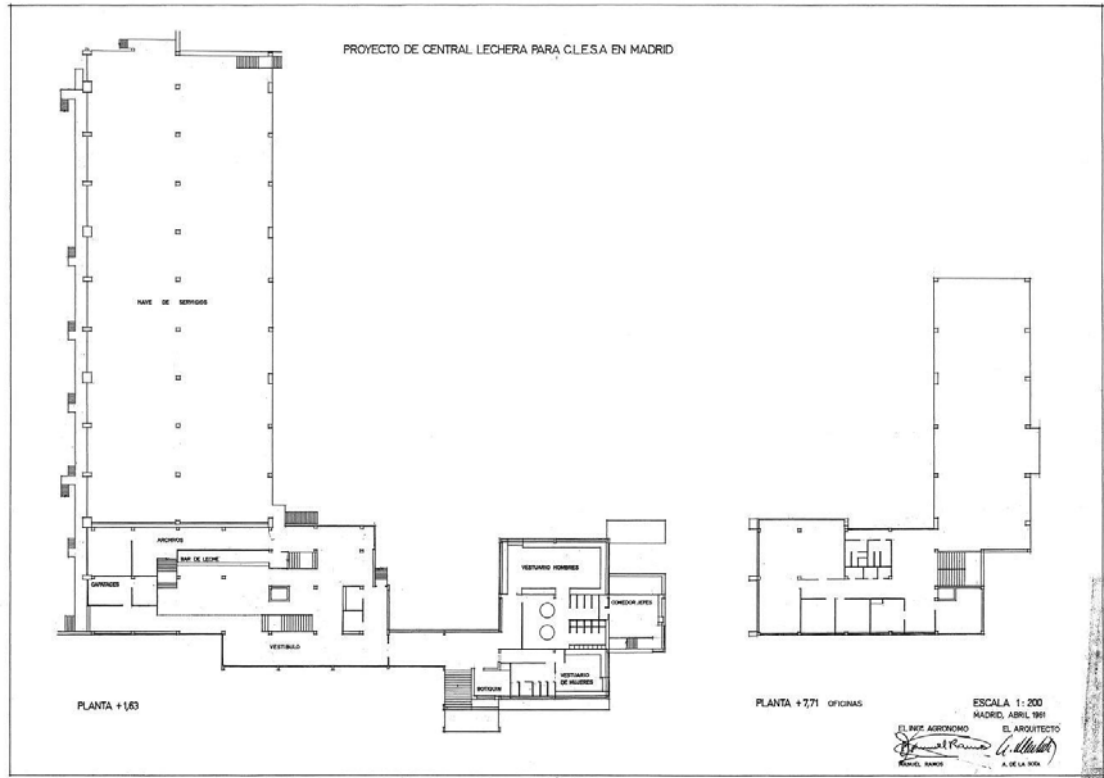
Planta intermedia, nivel +1,63. 1961. Fundación A. de la Sota. Norte hacia abajo.
